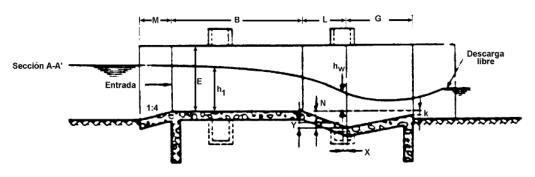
Perfil Canal Parshall. (César, 2003)
